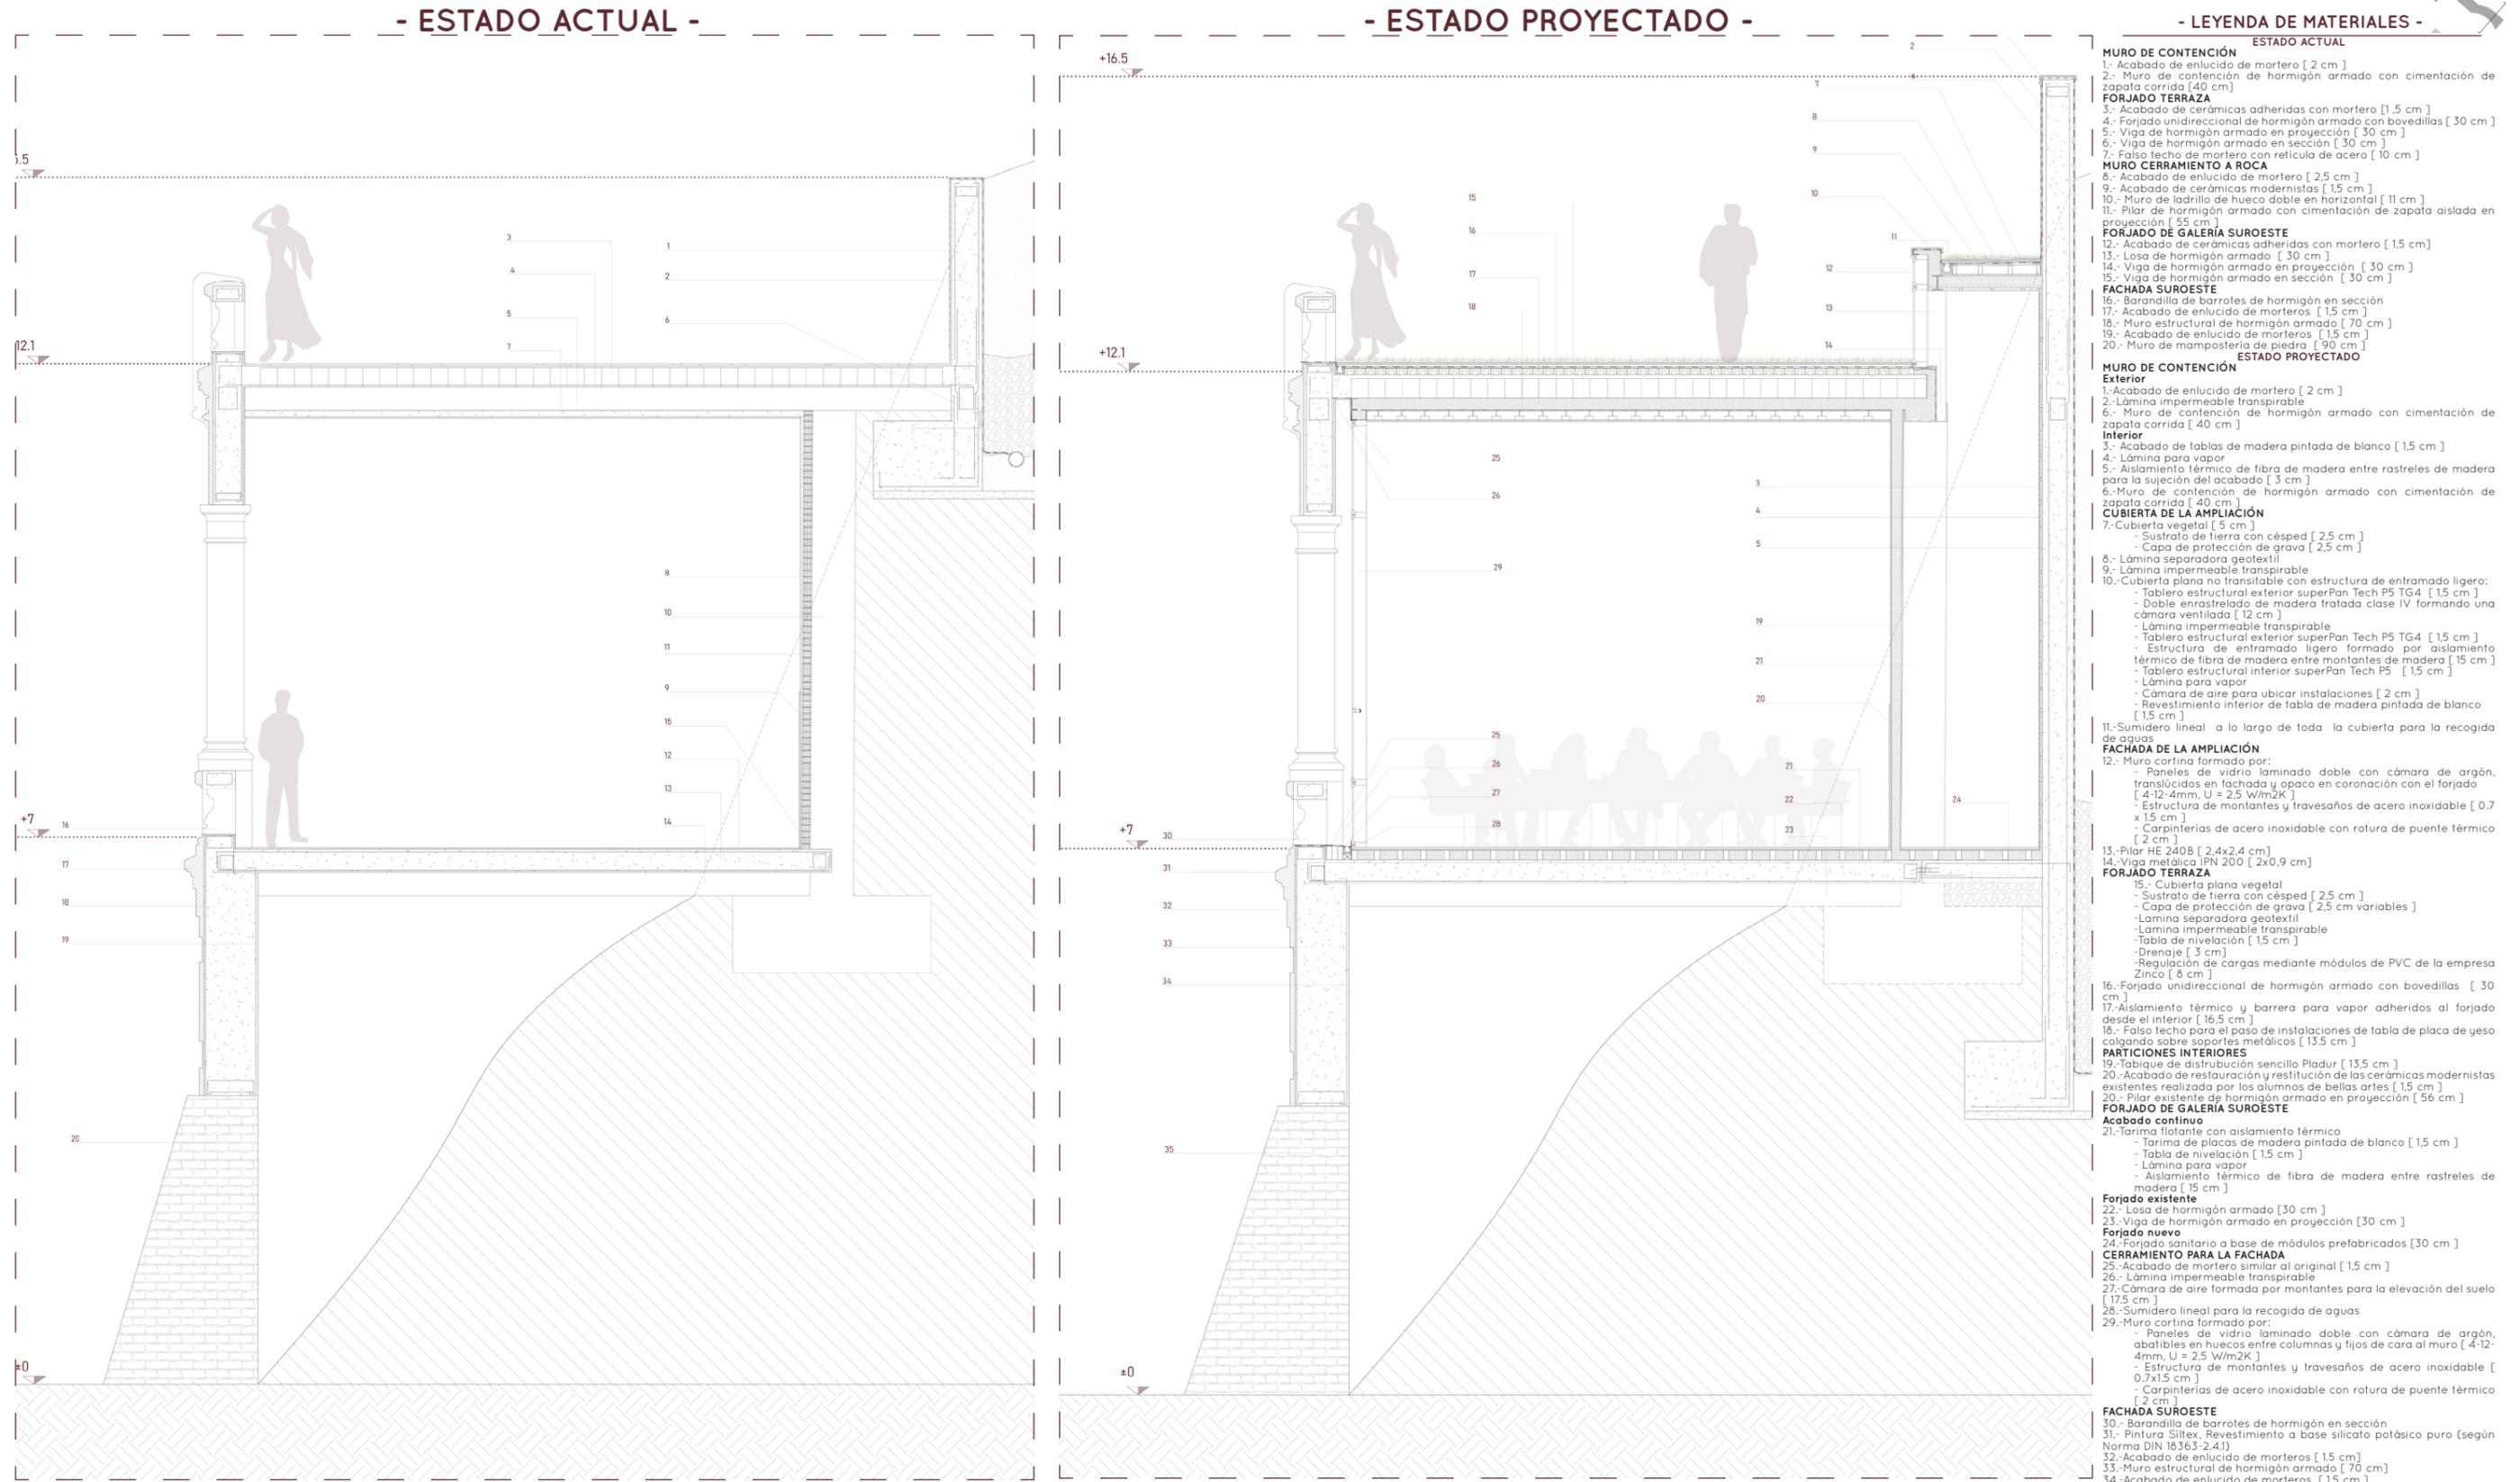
Comparativa de secciones por la galería suroeste de estado actual y estado proyectado.
